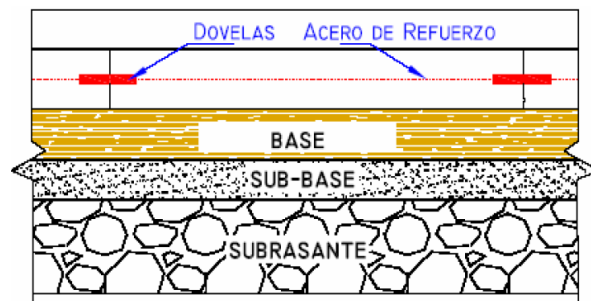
Vista en perfil de una losa de hormigón reforzado y con juntas (INVIAS, 2006)
